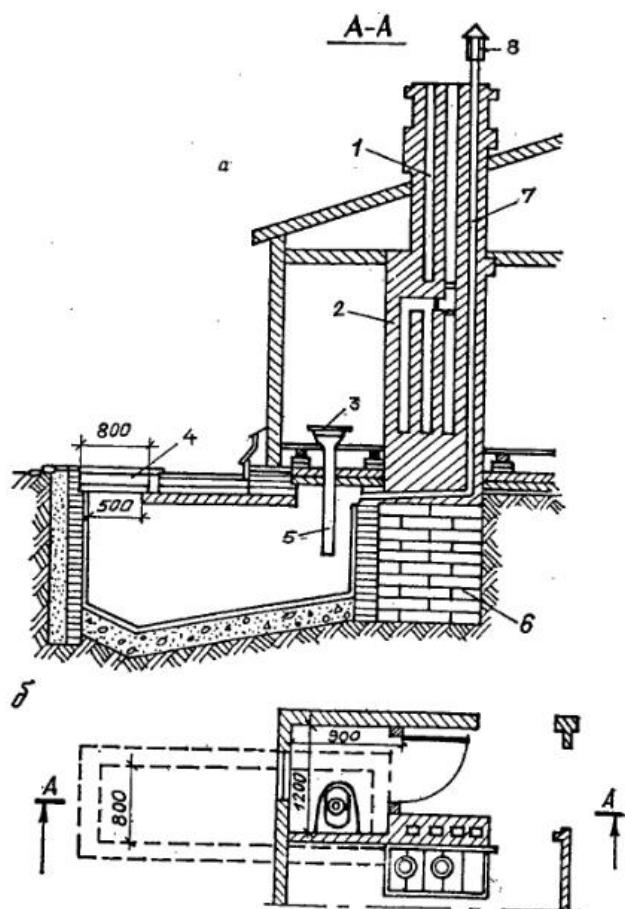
Люфт-клозет: а — разрез; б — план. 1 — вентиляционный канал из кухни; 2 — щиток кухонной плиты; 3 — приемная воронка; 4 — крышка люка; 5 — сточная труба; 6 — фундамент печи; 7 — люфт-канал; 8 — дефлектор.
